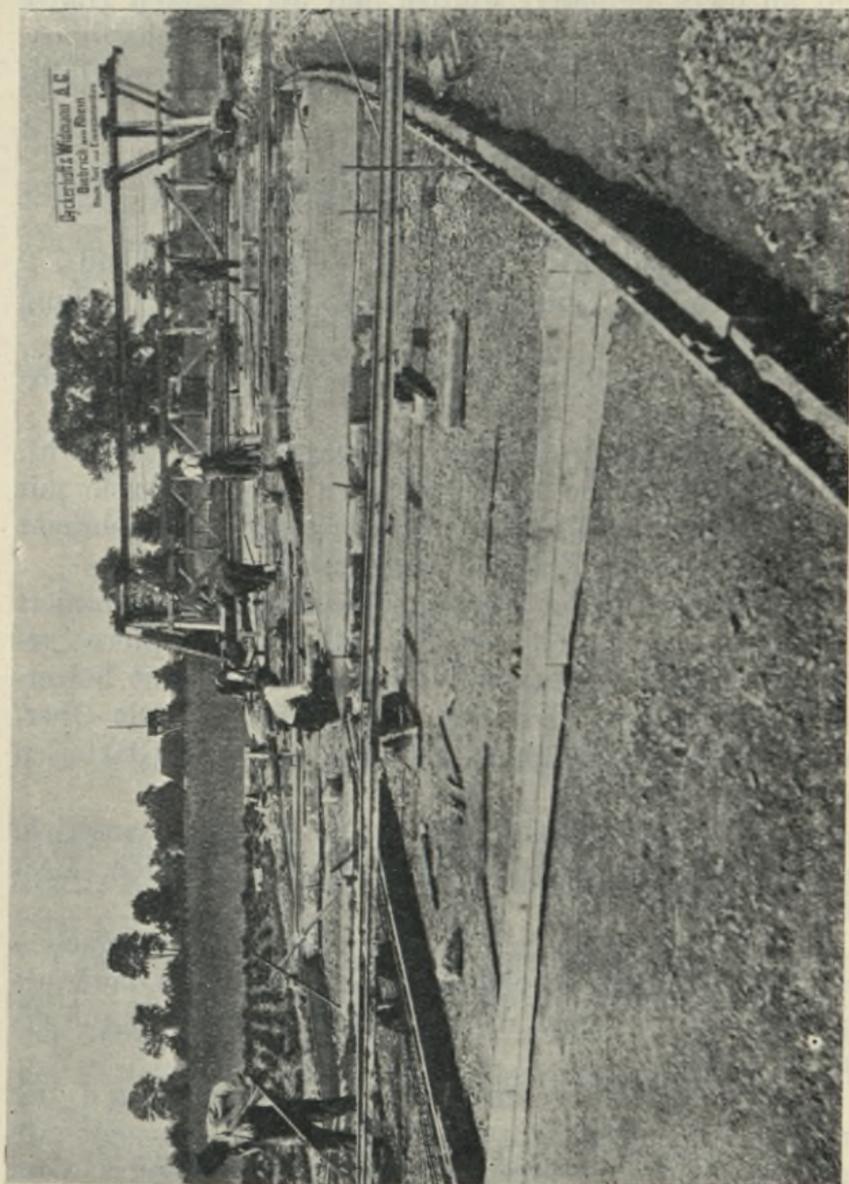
Betonversuchsstrecke Braunschweig. Schachbrettartige Ausführung.
